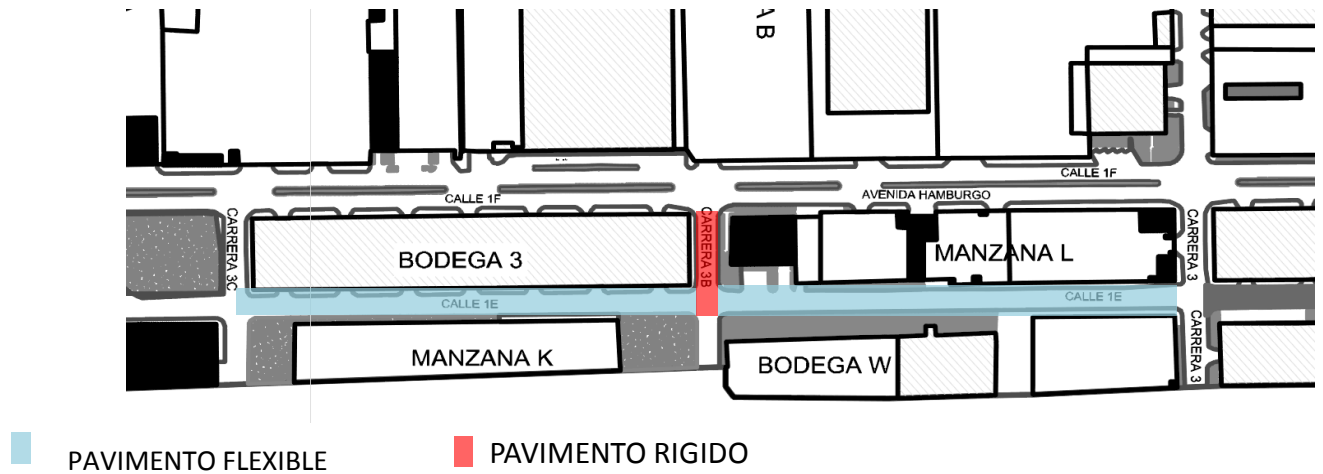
Plano General Zona Franca Barranquilla. Fuente: Base de datos ZFB
